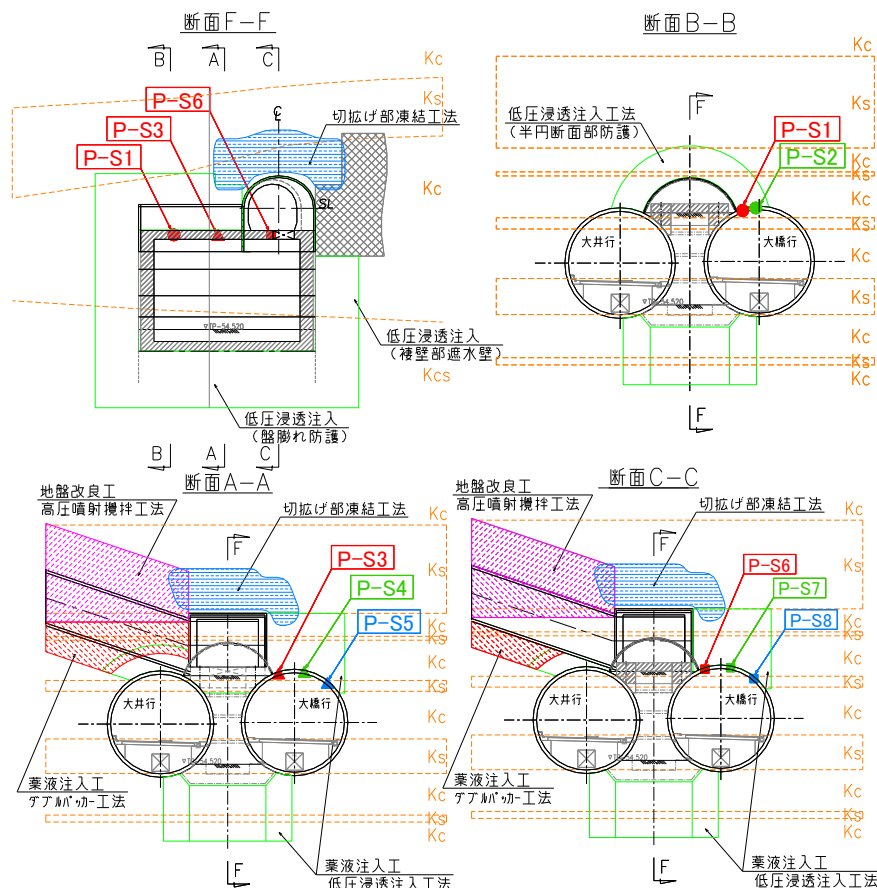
地盤改良工と間隙水压測定位置の縦横断面図
